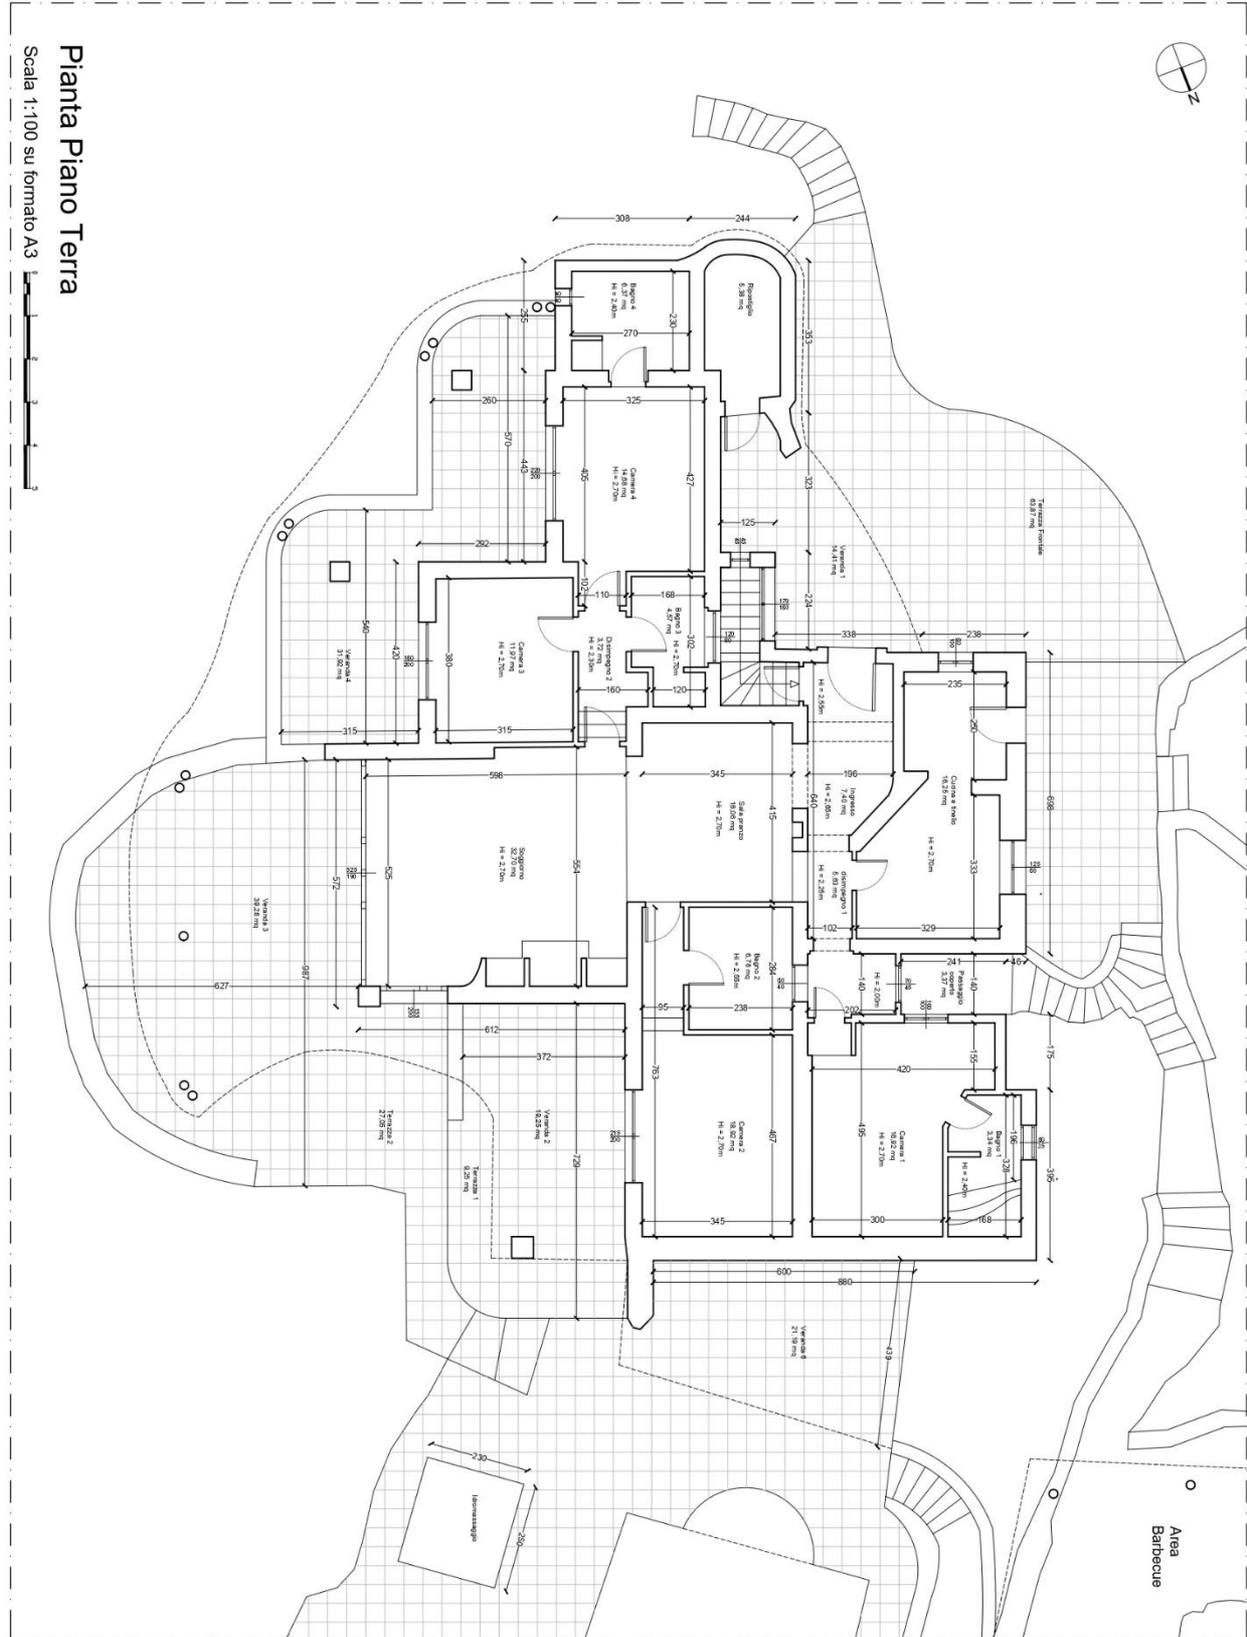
Planimetria dello stato di fatto – pianta del piano terra
